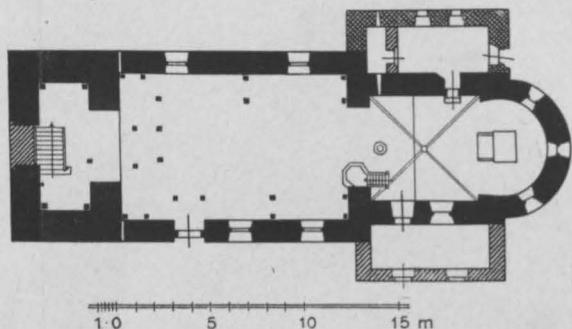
Friedersdorf b. D. Grundriß der Kirche.
